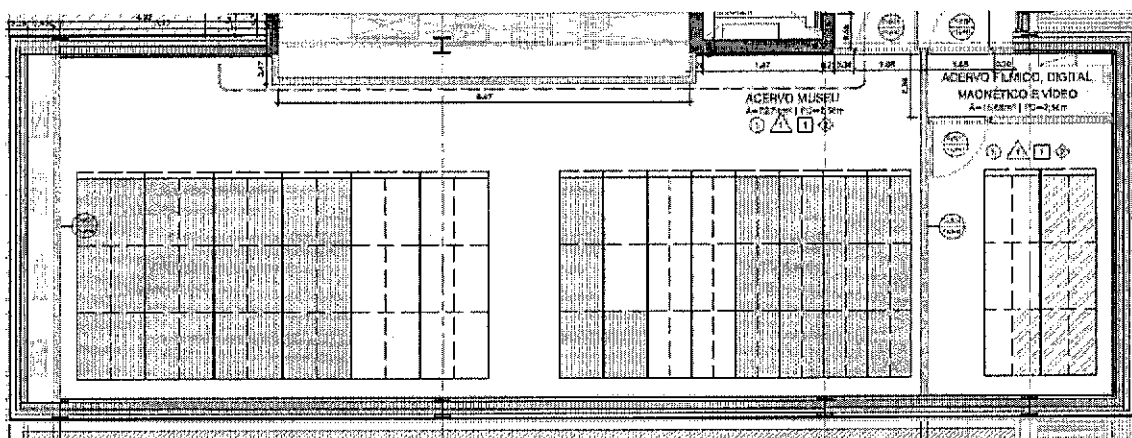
planta do 4º pavimento do objeto licitado, com área de arquivo com 88,42m².
